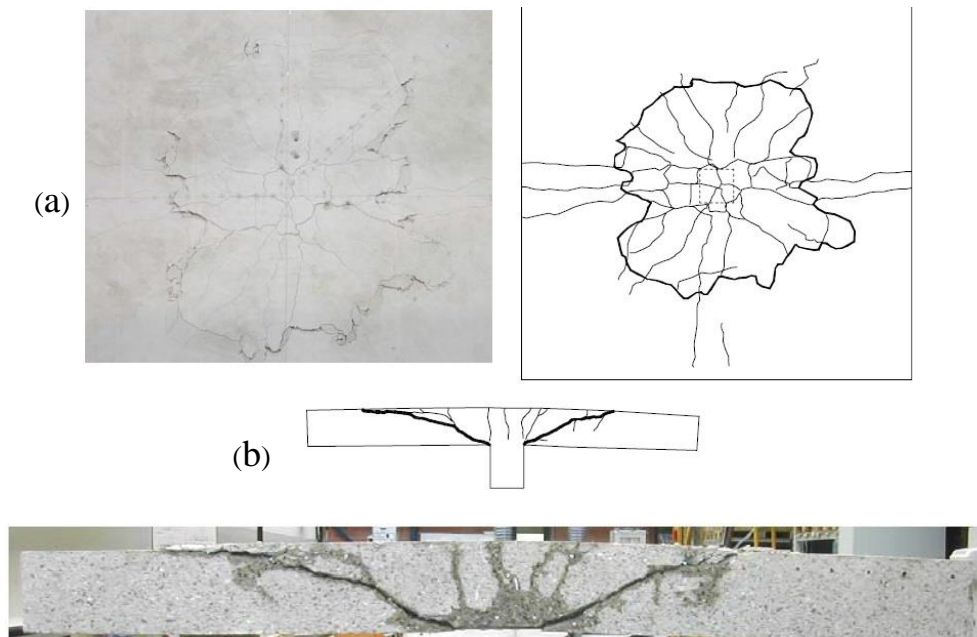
Exemple de rupture par poinçonnement de dalle en béton armé : (a) face supérieure ; (b) coupe transversale Guandalini et Muttoni, 2004 [21]
